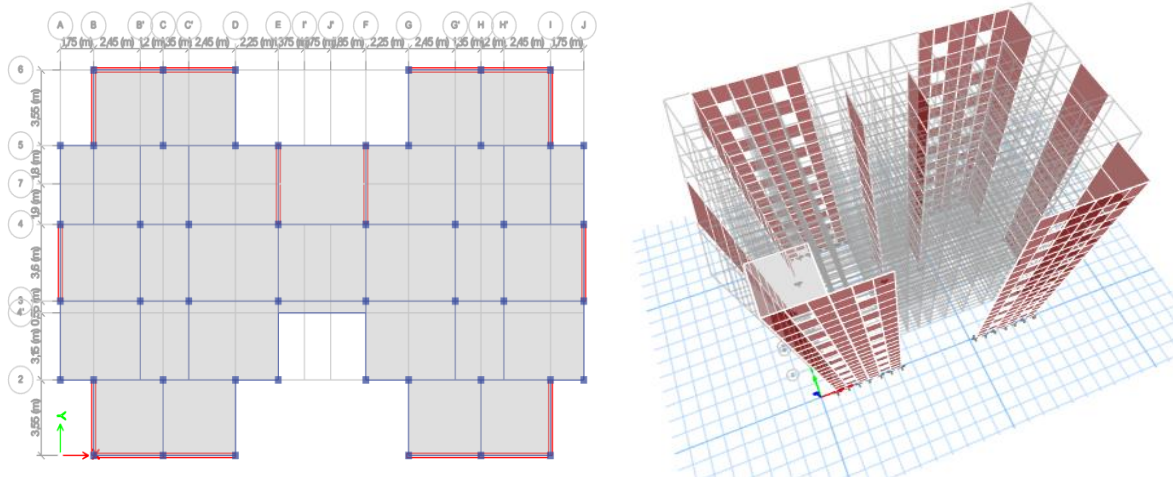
Modèle de disposition des voiles et vue en plan 3D
